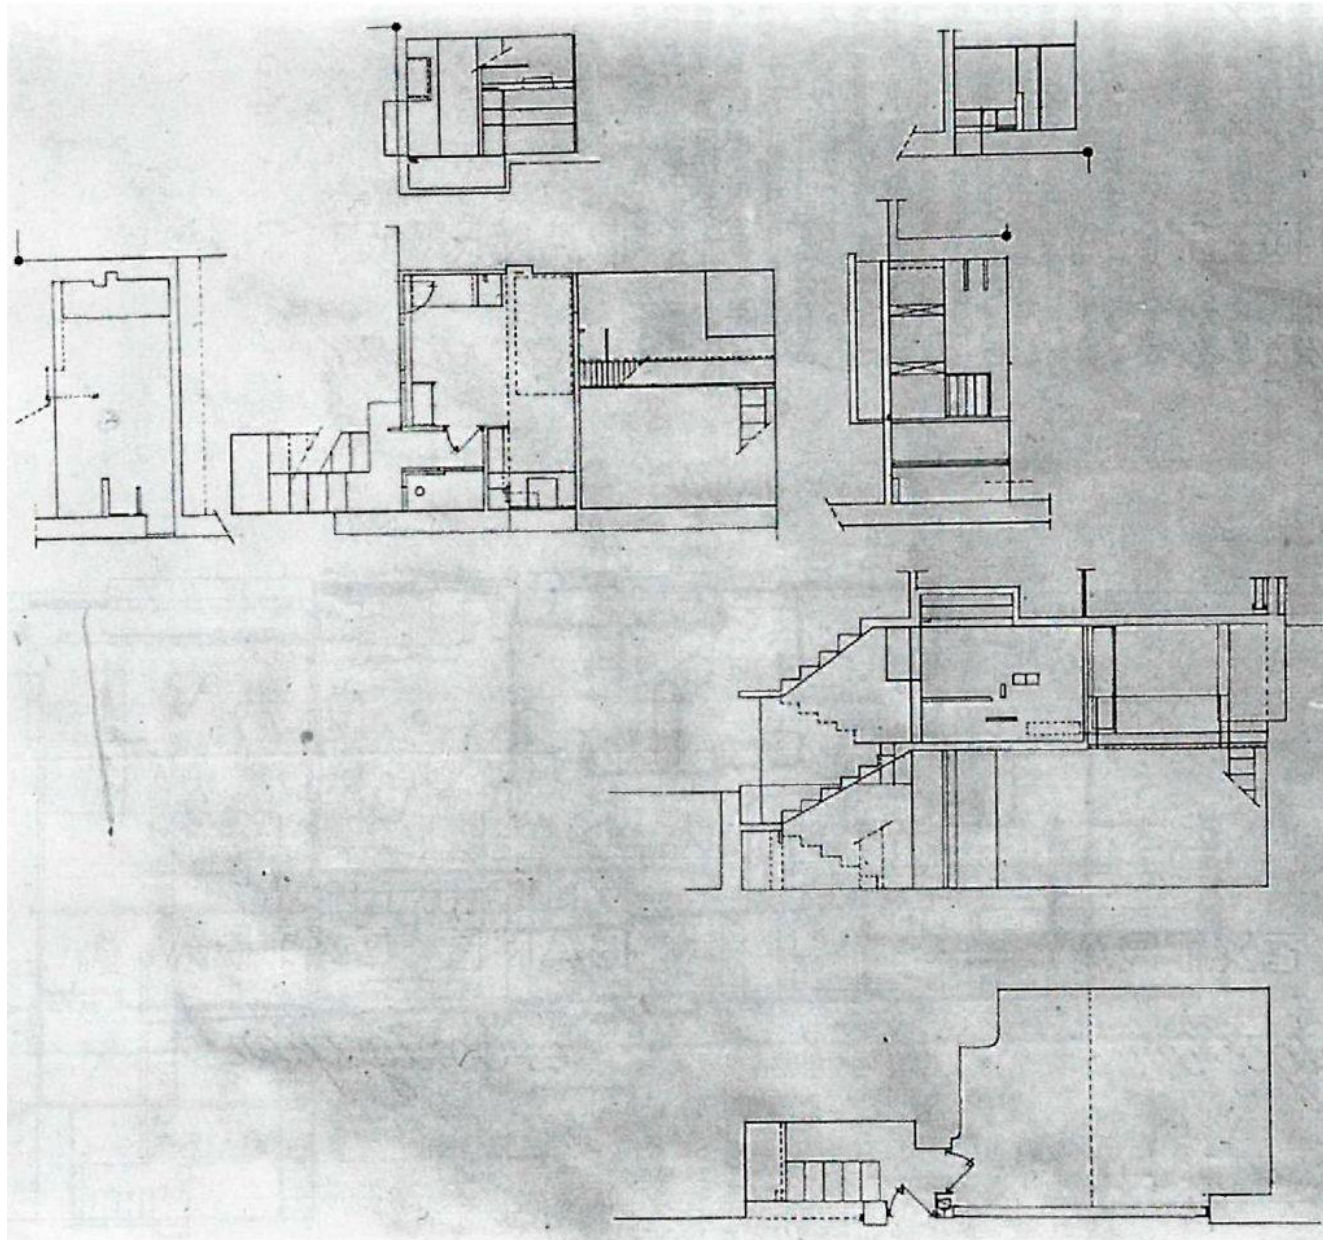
Eileen Gray, plano parcial plantas inferiores Tempe à Pailla.
